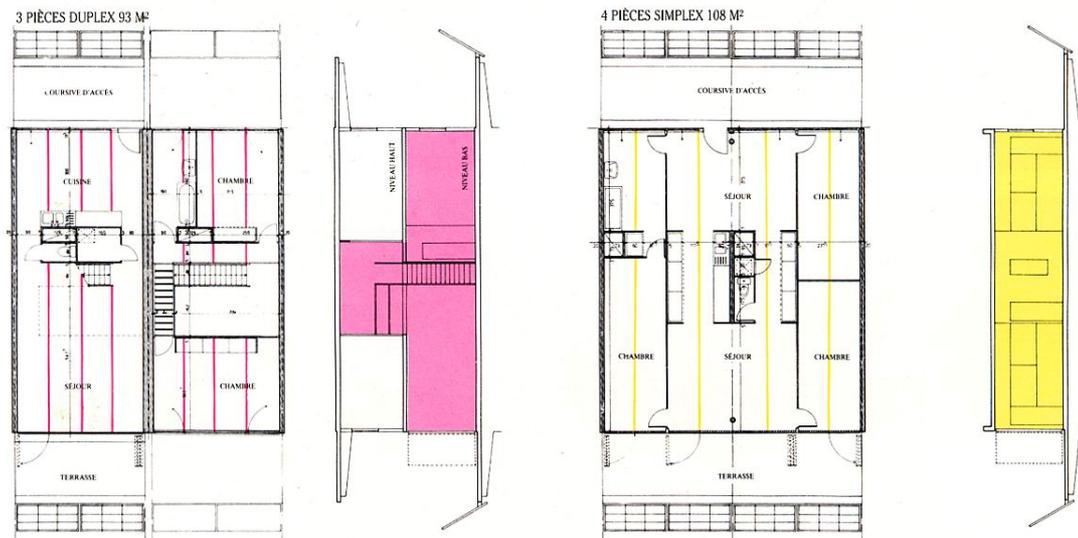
Plantas e cortes Conjunto Nemausus – Jean Nouvel
